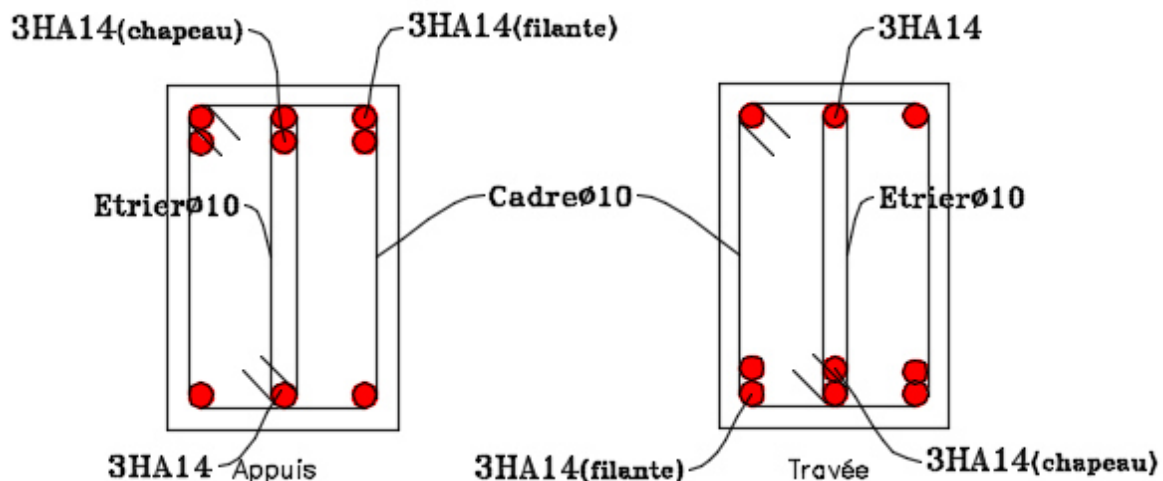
Schéma de ferrailage de la poutre de chaînage.
